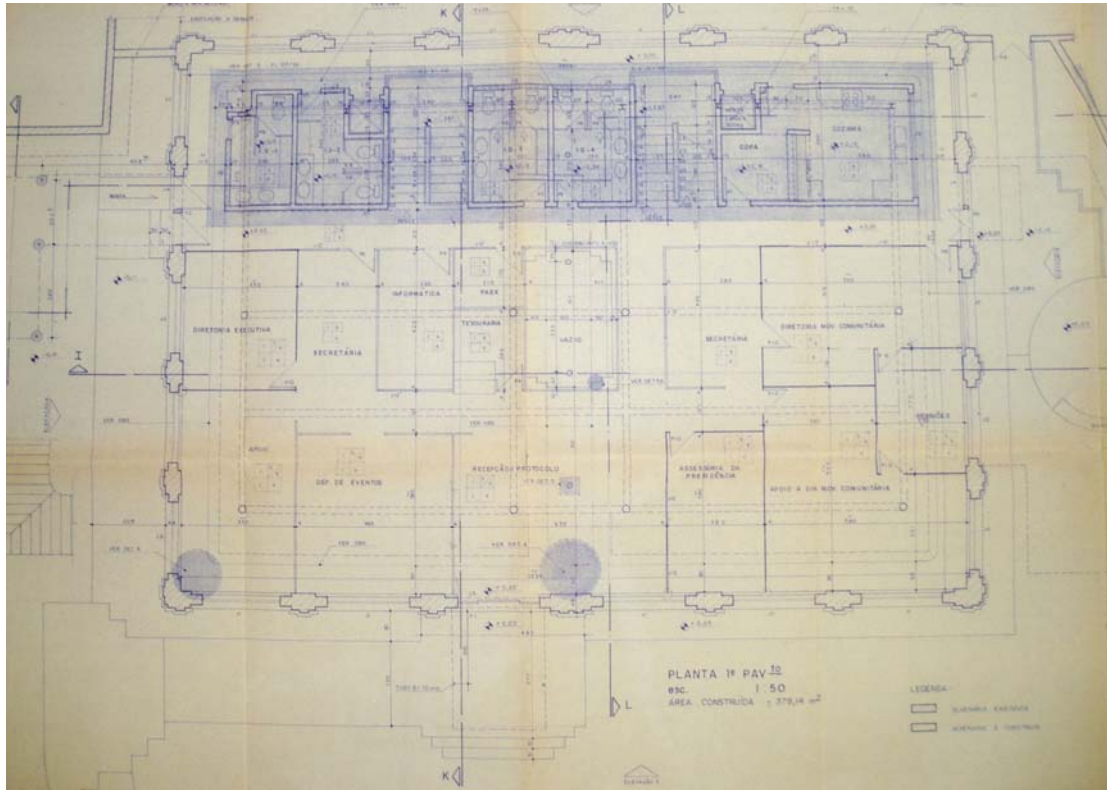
Fotografia da Planta Primeiro Pavimento (Arquivo do IEPHA-MG).
